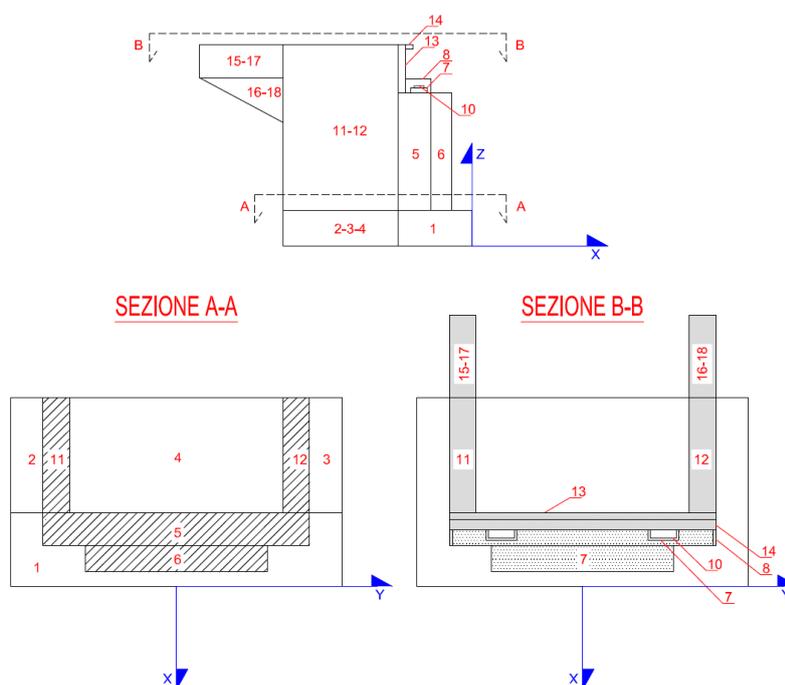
Schema qualitativo della geometria della spalla
